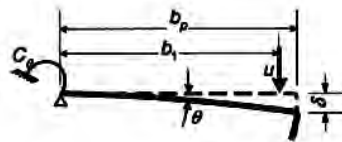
Elementi piani delimitati da un'anima e da un irrigidimento di bordo
